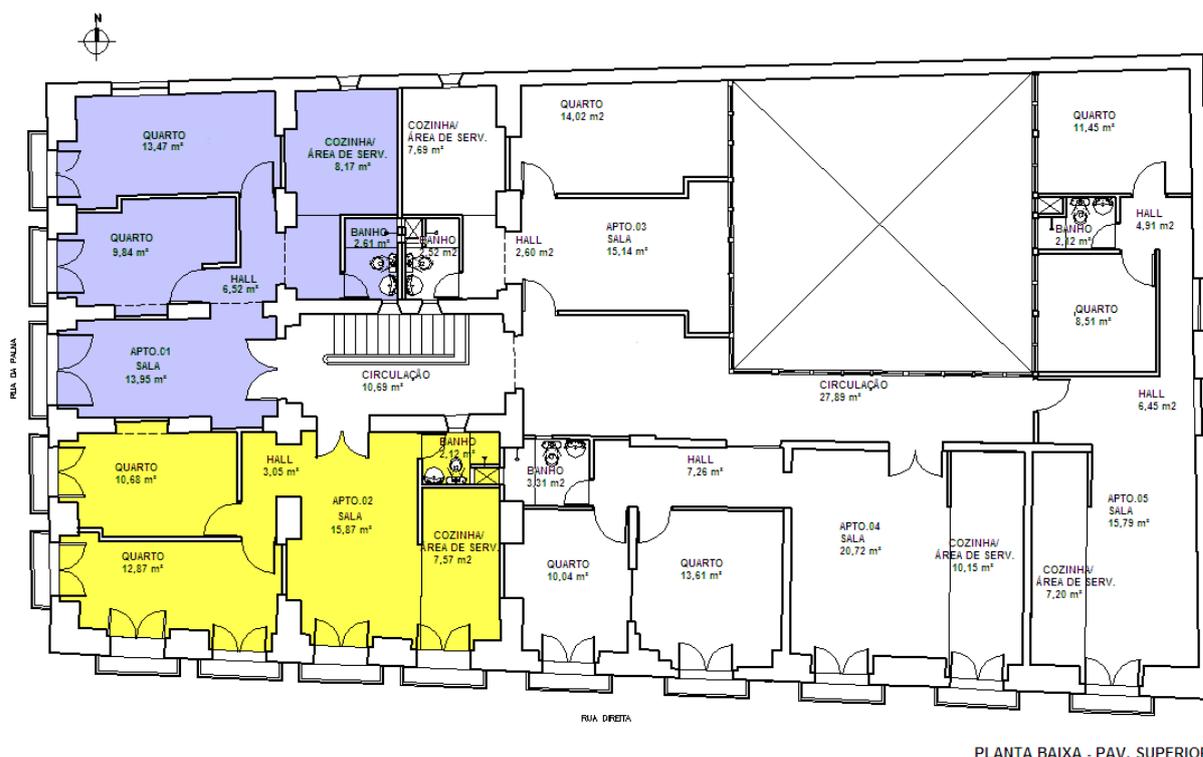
Ilustração de Planta Baixa de Pavimento Superior - Fonte: Própria, 2009.
